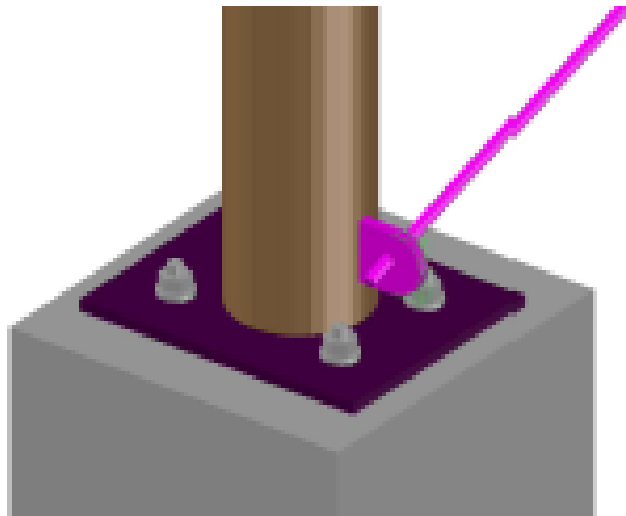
Detalle de anclaje de estructura metálica para cubierta Cancha Colegio de Sora y Escuela Pita Chone. Fuente: Planos proyecto
